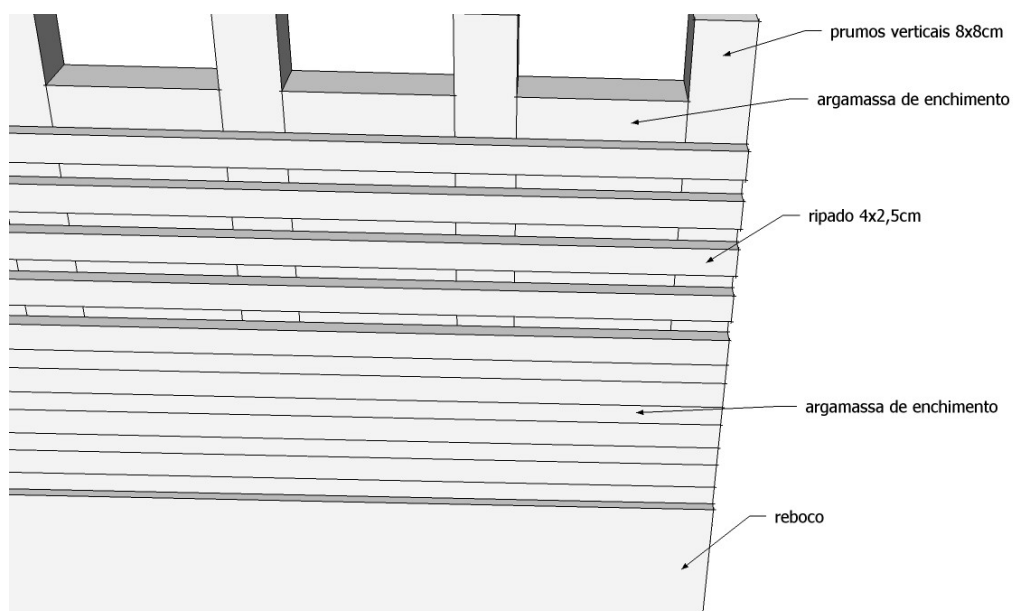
Madeira com enchimento e revestimento em argamassa de terra – desenho esquemático.
